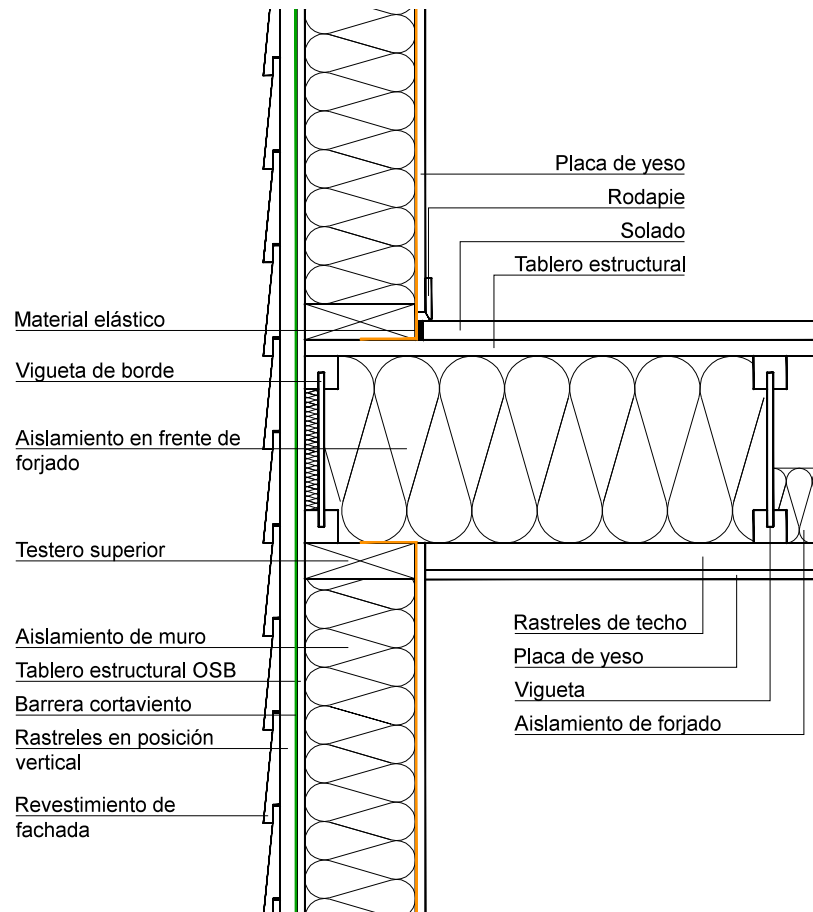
Detalle tipo del encuentro entre el forjado y un muro de fachada en el sistema de plataforma.
